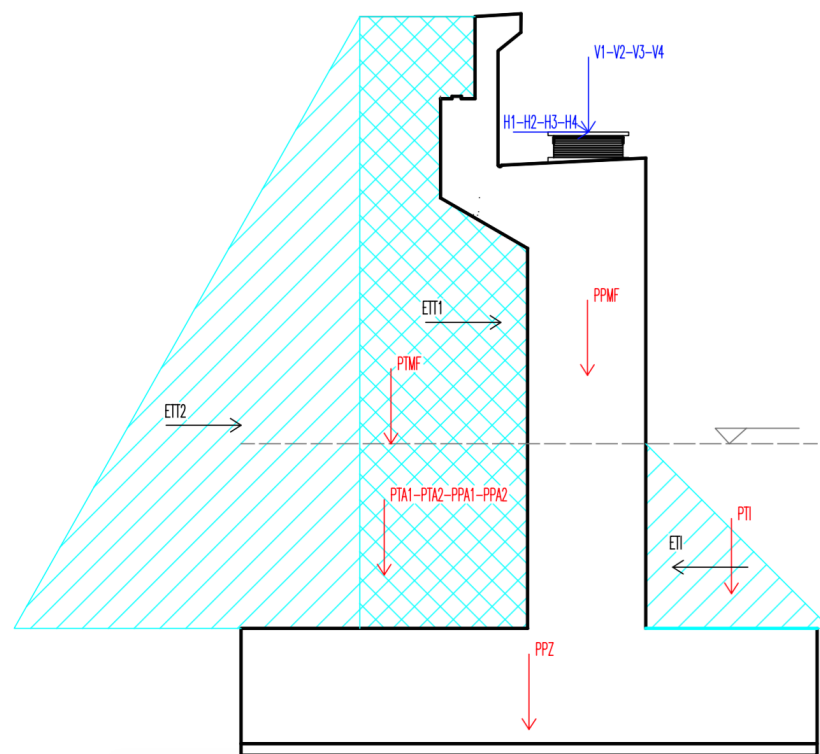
a. Cargas sobre el estribo. Sección estribo.
